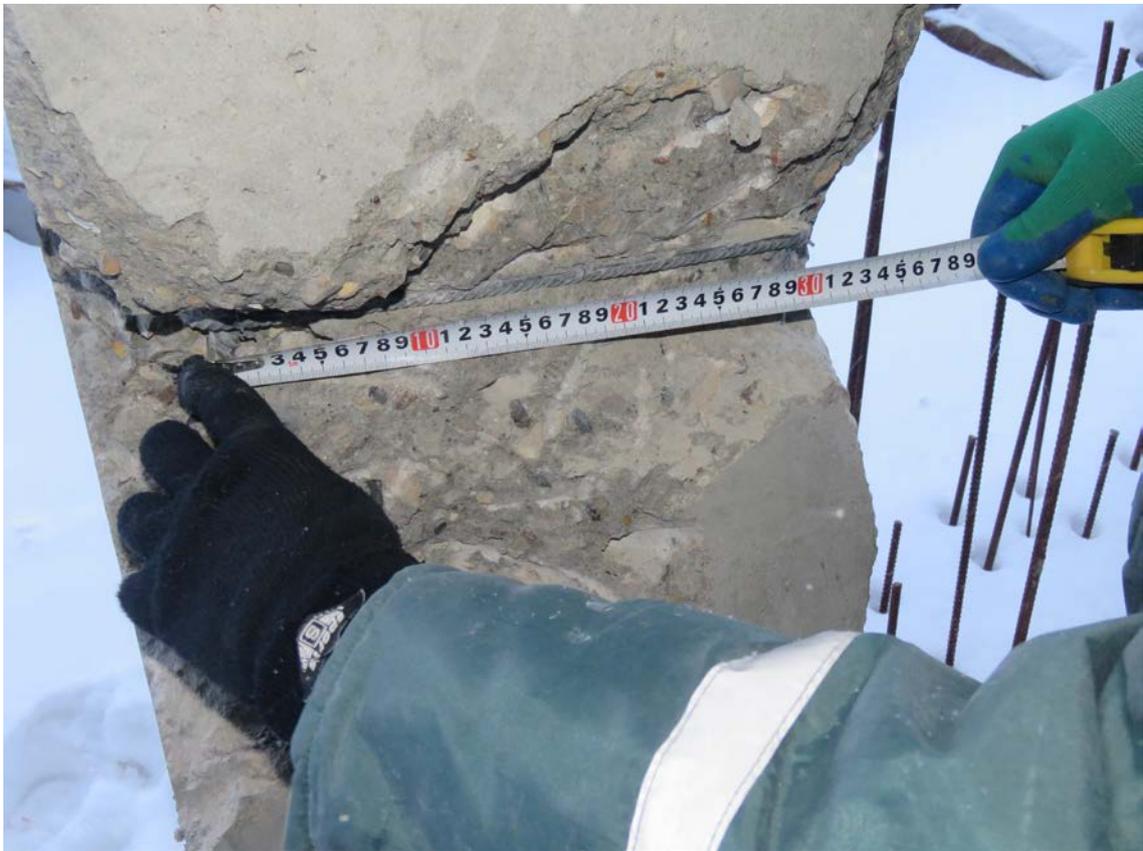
Замер шага арматурных стержней в монолитной колонне в уровне подвального этажа в осях 26/1/М/1-Н/1
